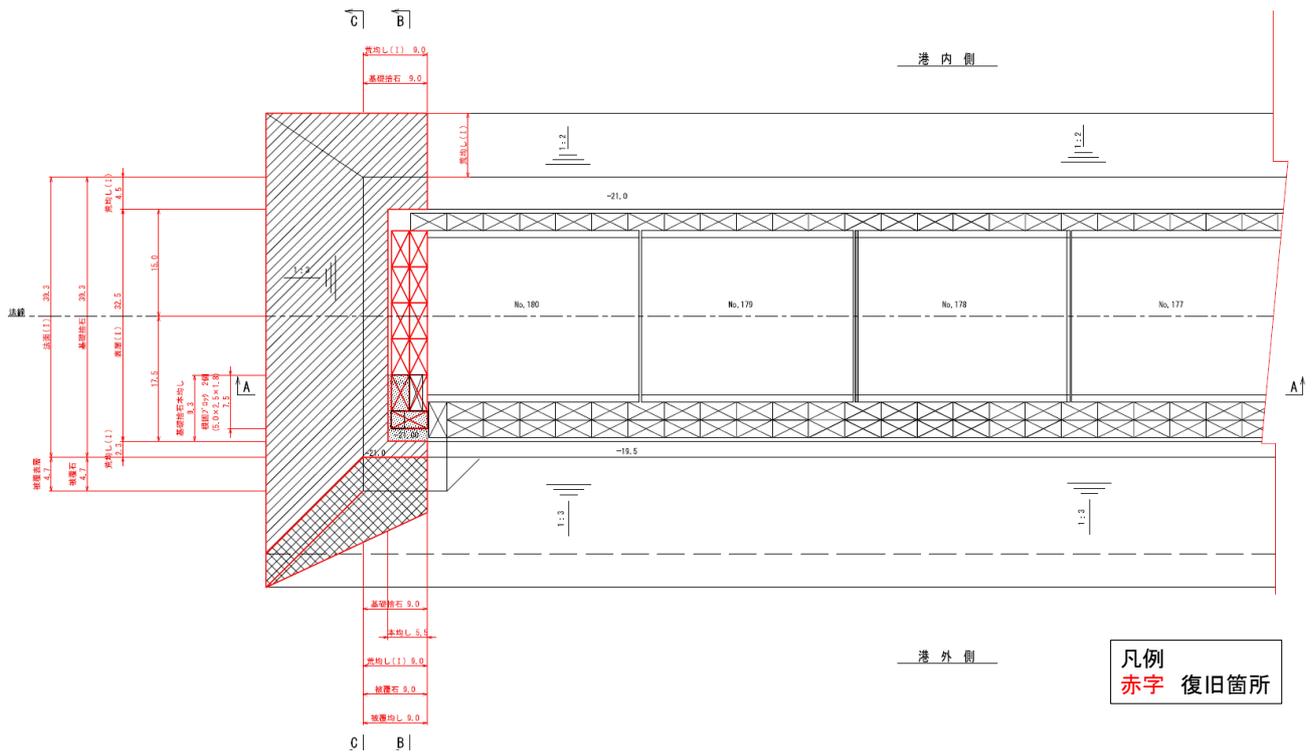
26 No.2 常陸那珂港区_東防波堤平面図 (復旧後)
